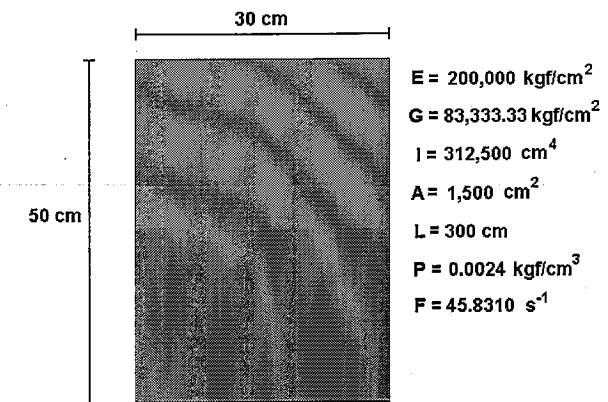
Sección transversal de una viga de concreto rectangular.
